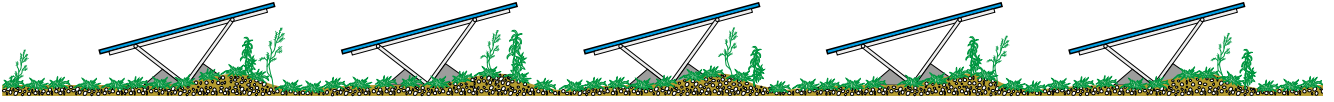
Installation PV orientée au sud avec une structure de substrat minimale, source: Contec
